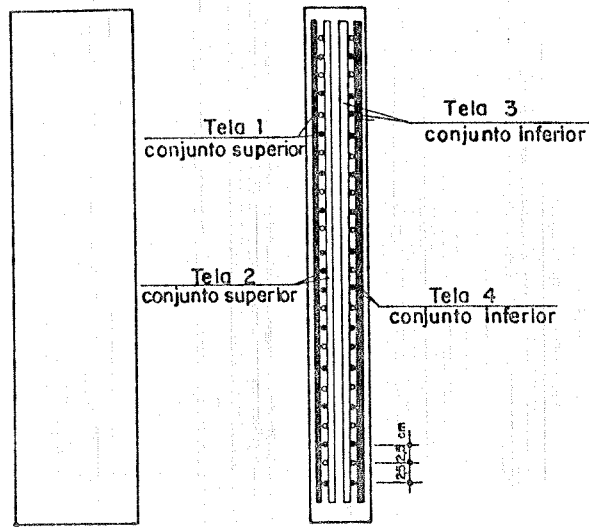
Arranjo de armaduras tipo II: malhas desencontradas
